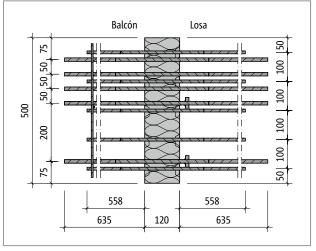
Schöck Isokorb® XT tipo C-L-M1-V1: Plano del producto
